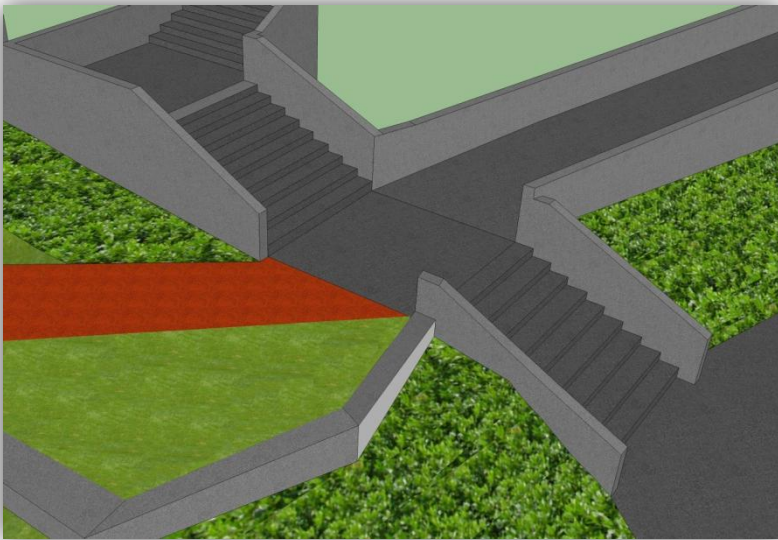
Perspetiva do acesso da zona norte da área de projeto
